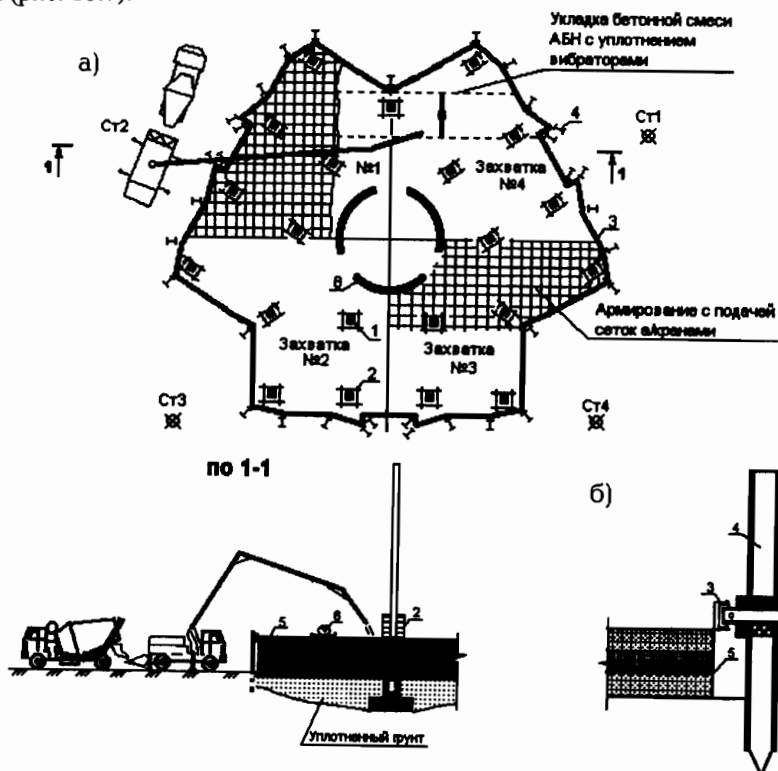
Технология устройства перекрытий: а - устройство опалубки, армирование и бетонирование плит с разбивкой на захватки; б - схема инвентарной опалубки; 1 - колонны; 2 - воротники; 3 - инвентарная опалубка; 4 - стойки по периметру плиты; 5 - монолитная плита; 6 - виброрейка; 7 - автобетононасос; 8 - ядро жесткости
